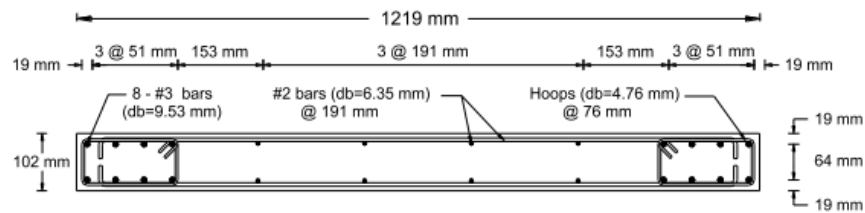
Detallado y refuerzo del espécimen RW2 (Thomsen & Wallace, 1995)
